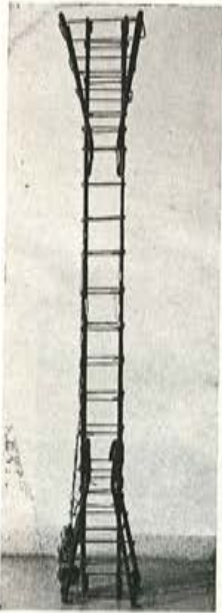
Detalle de la armadura con las bandas extensométricas.
